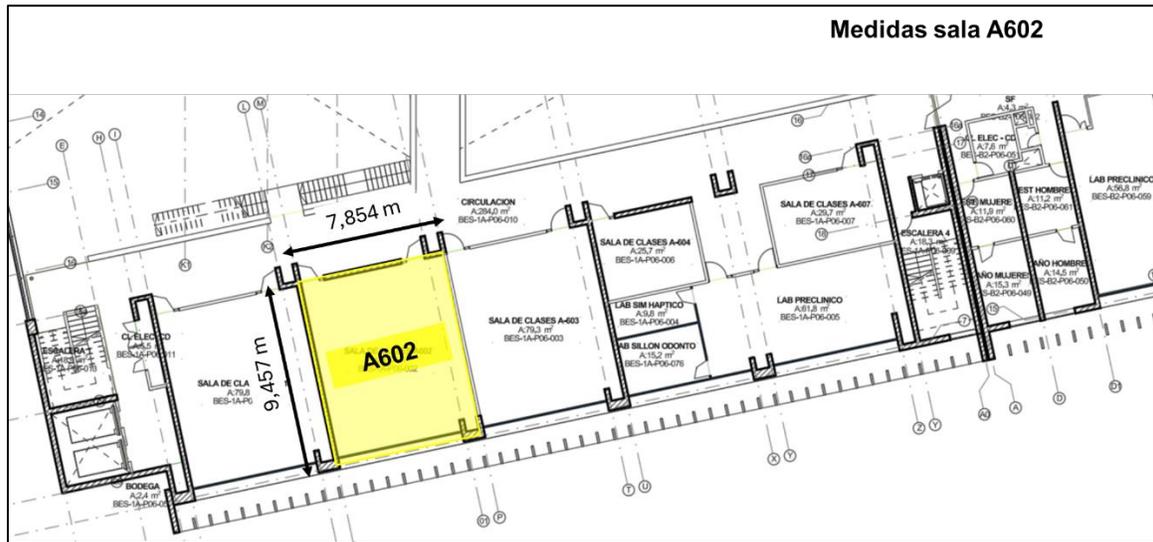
Dimensiones en metros sala A602 Sede Bellavista Sede Bellavista - AutoCAD
